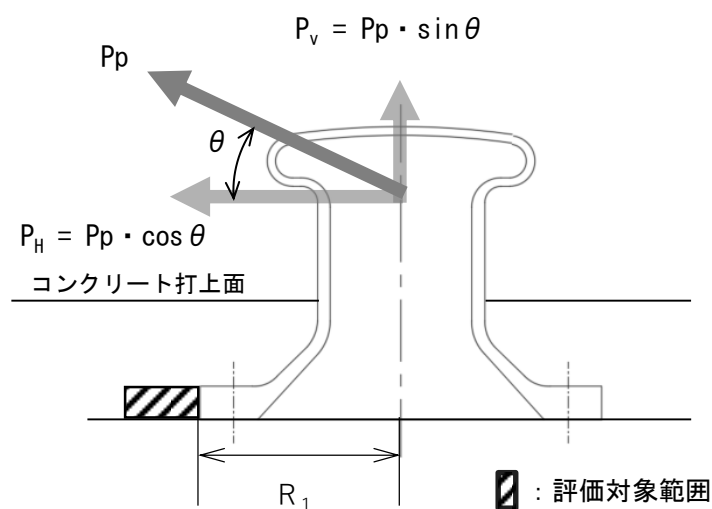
コンクリート（係船柱前面）のモデル図
